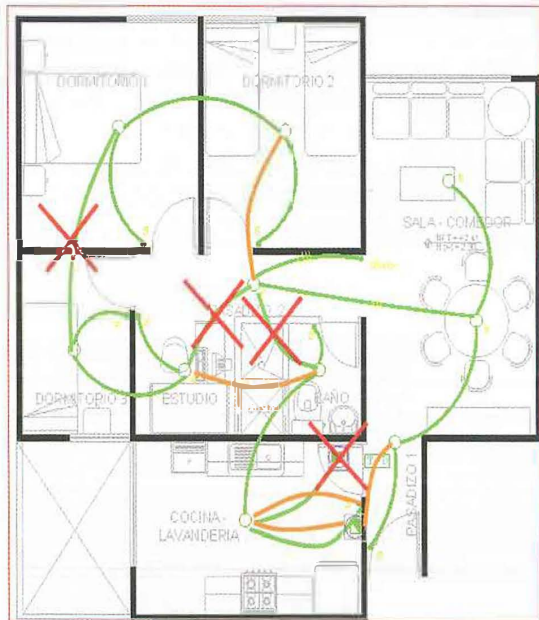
Ahorro de tuberías en la Distribución Eléctrica en la losa maciza
